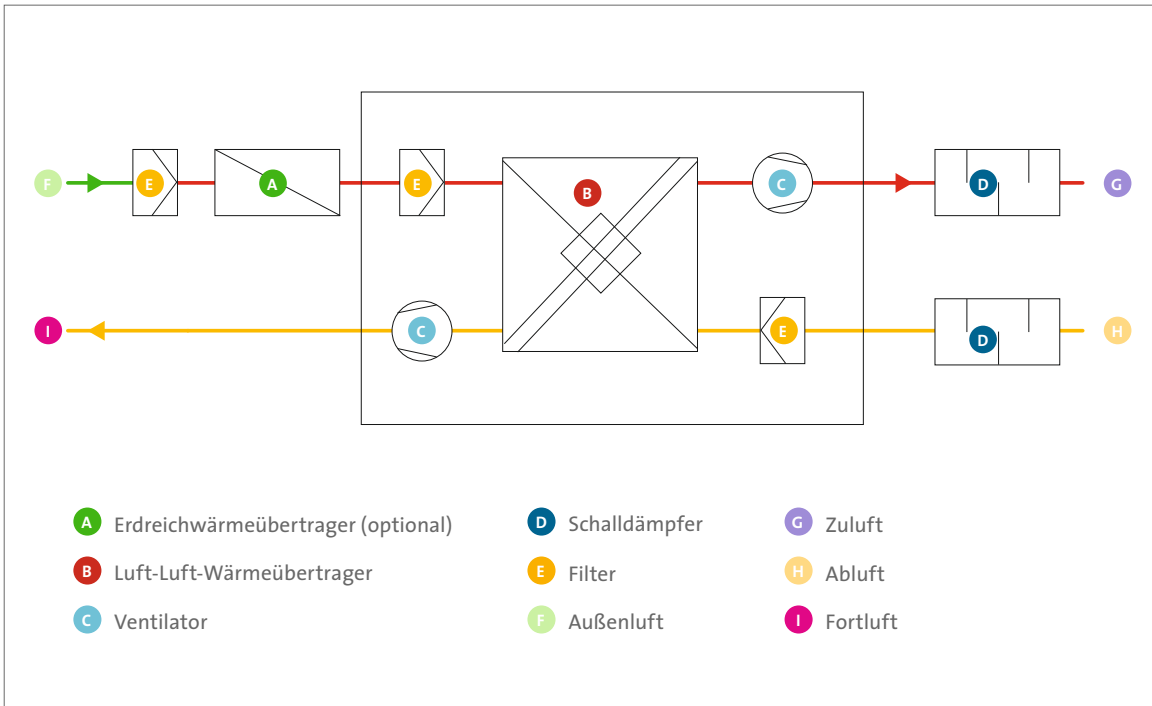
Prinzipschema zentrale Lüftungsanlage mit WRG
